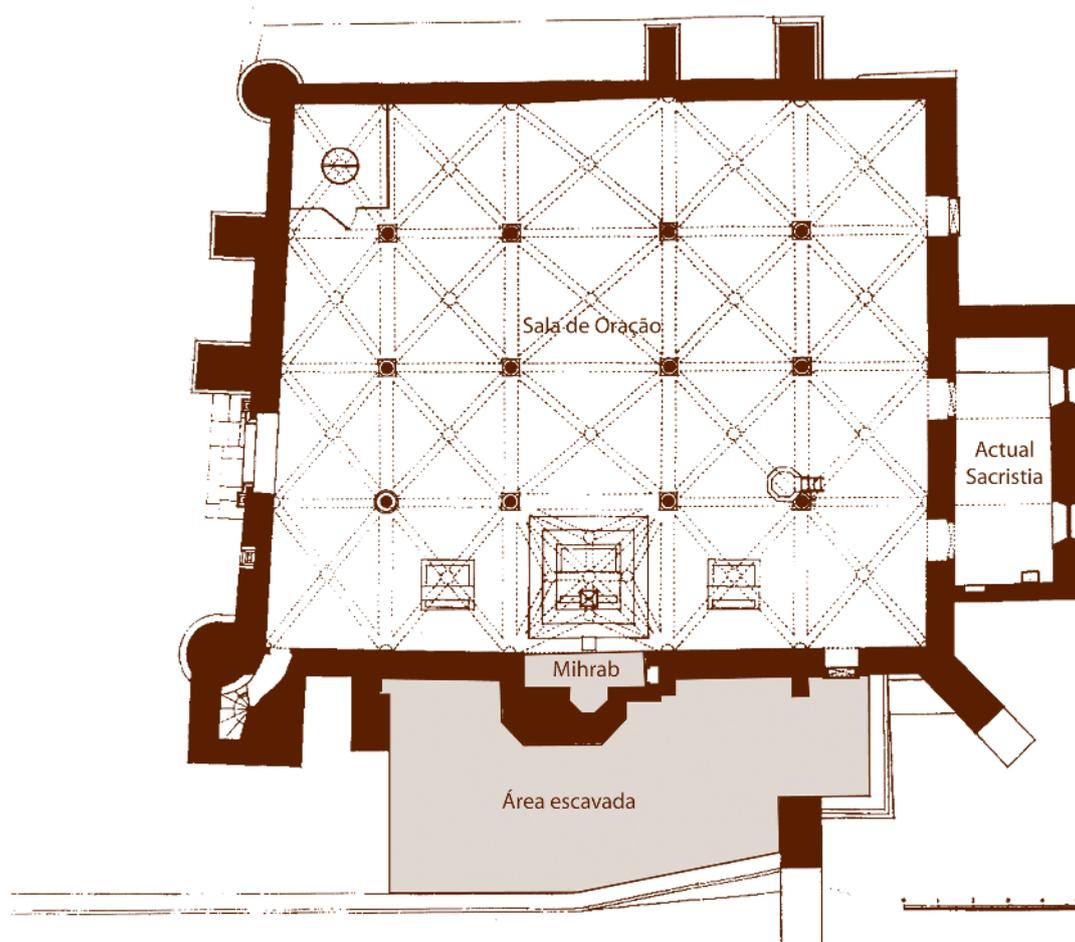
Planta geral das áreas escavadas na Mesquita de Mértola.
